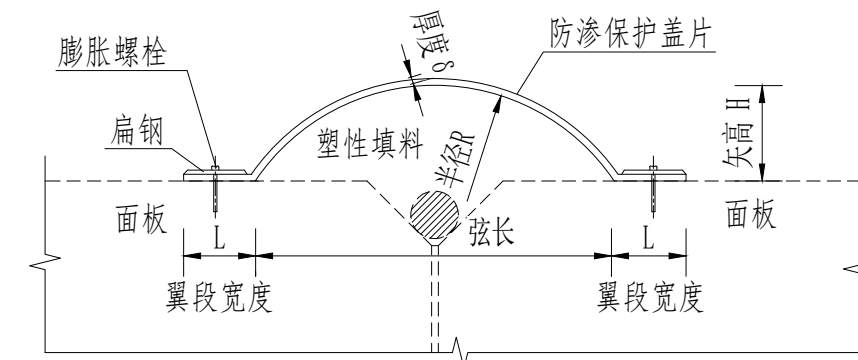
压性缝 (A型缝) 防渗保护盖片剖面图
